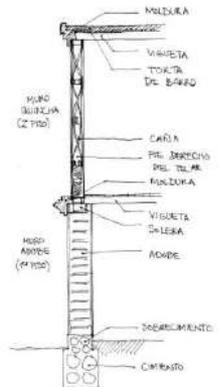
Detalle constructivo de la fachada. Fuente: M. Rosario Velasco García.
